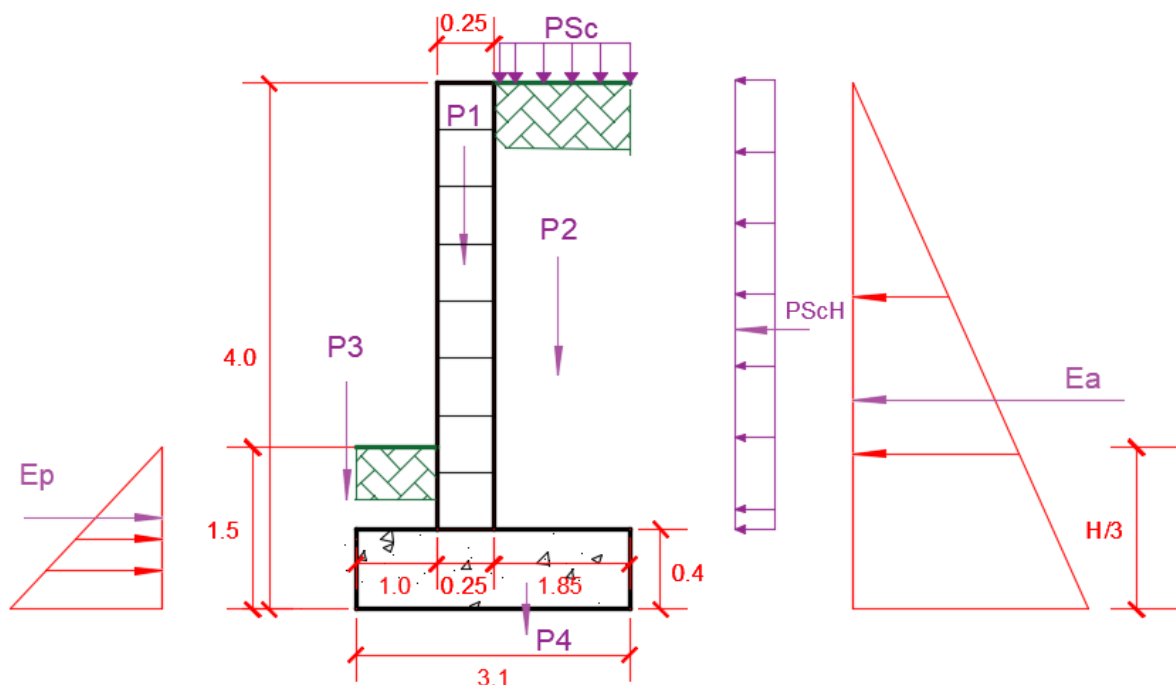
Predimensionamiento de muro de contención en mampostería confinada. Autores (2020).
